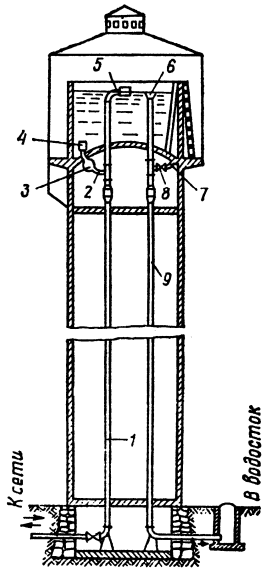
Схема оборудования водонапорной башни трубопроводами:
